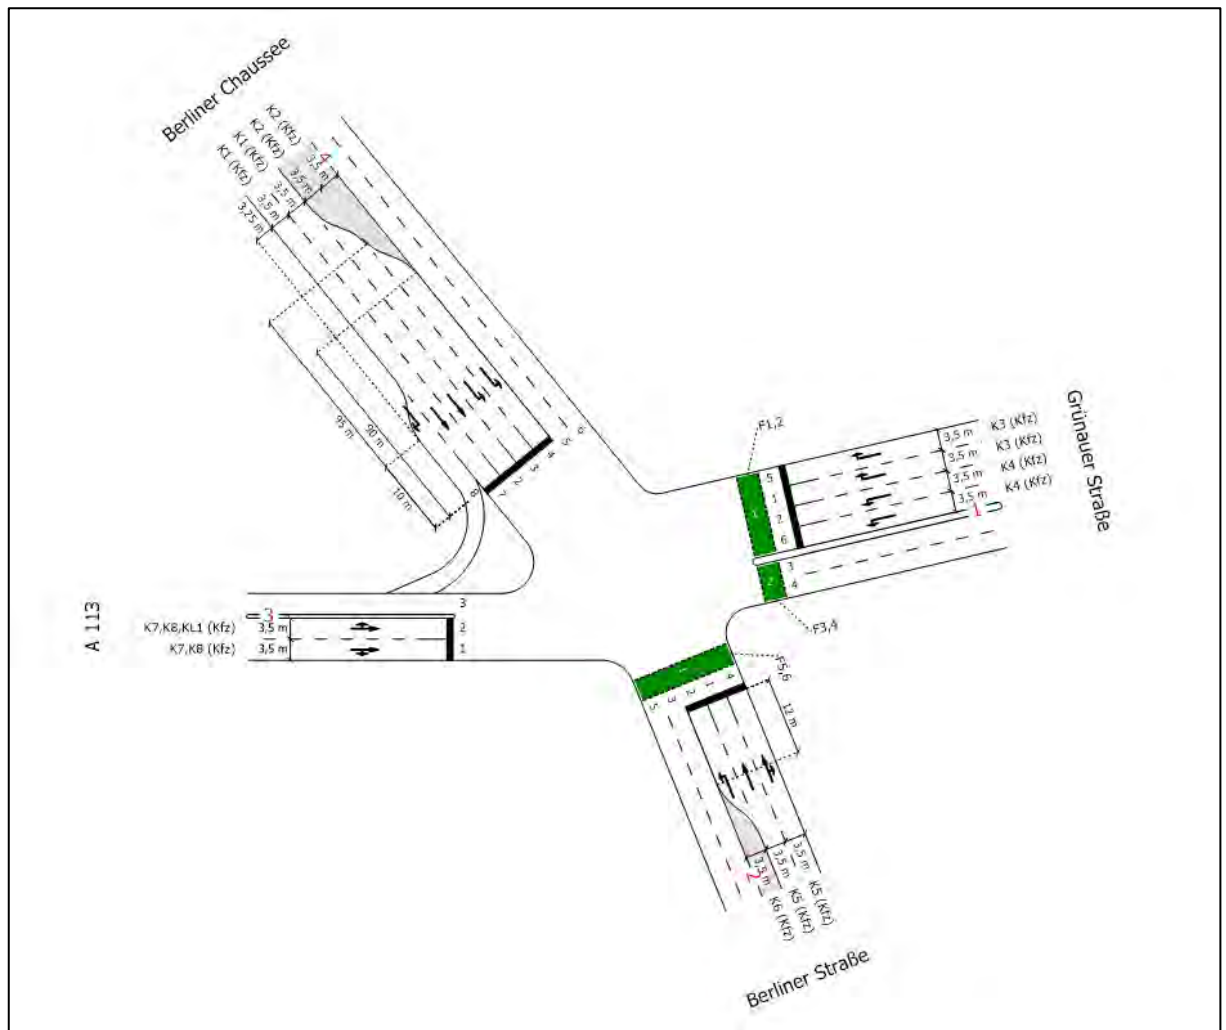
Geplanter Ausbauzustand im Prognose-Planfall des Knotenpunktes Berliner Straße (L400) / Grünauer Straße (L400) – AS Waltersdorf (K4)
